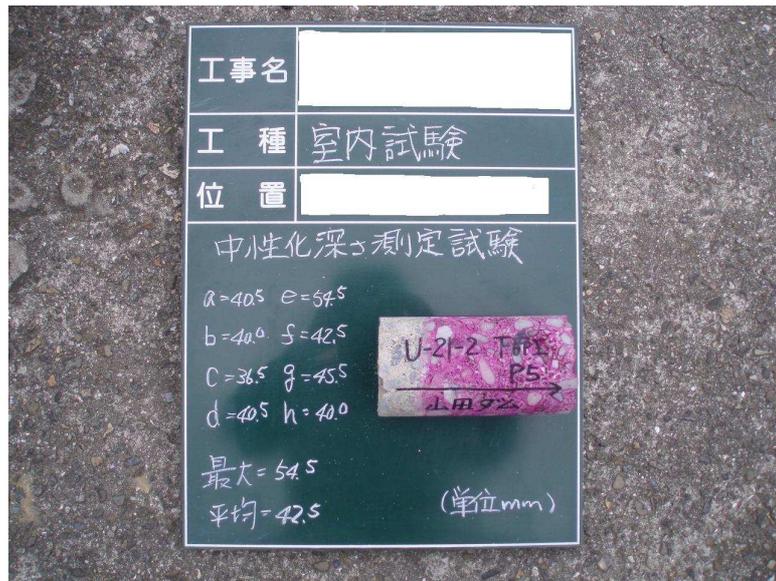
コンクリートコアによる中性化深さ測定試験の事例
